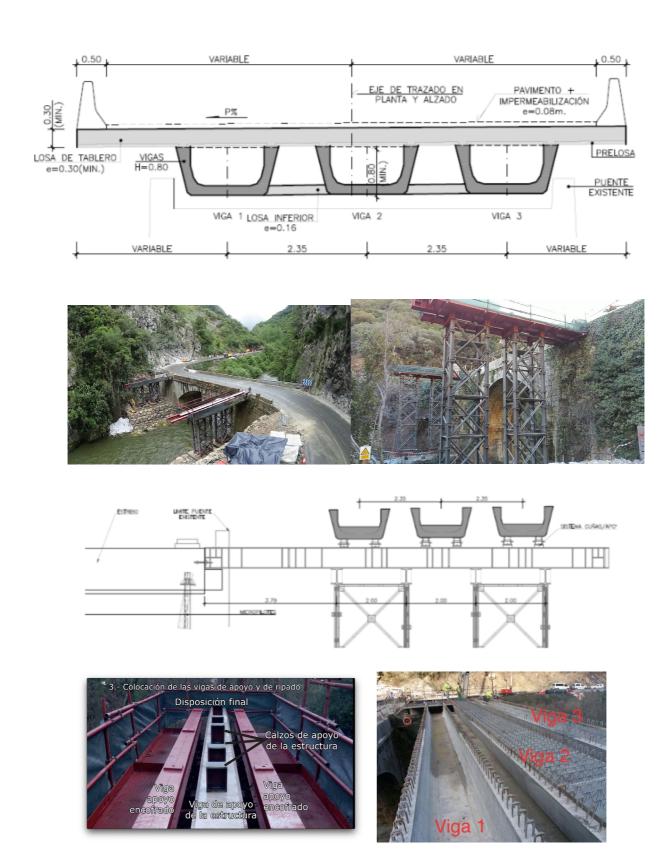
Estructura provisional aguas abajo y vigas prefabricadas apoyadas en estructura provisional.
